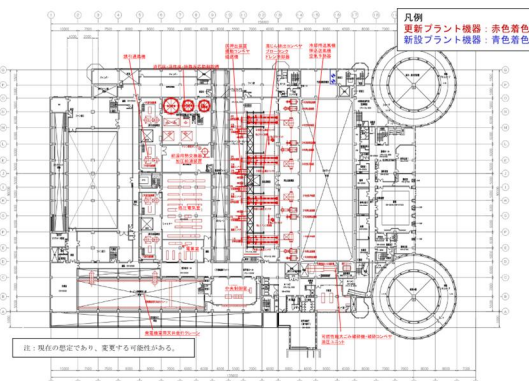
(4) 設備機器の更新箇所 (4 階平面図)
